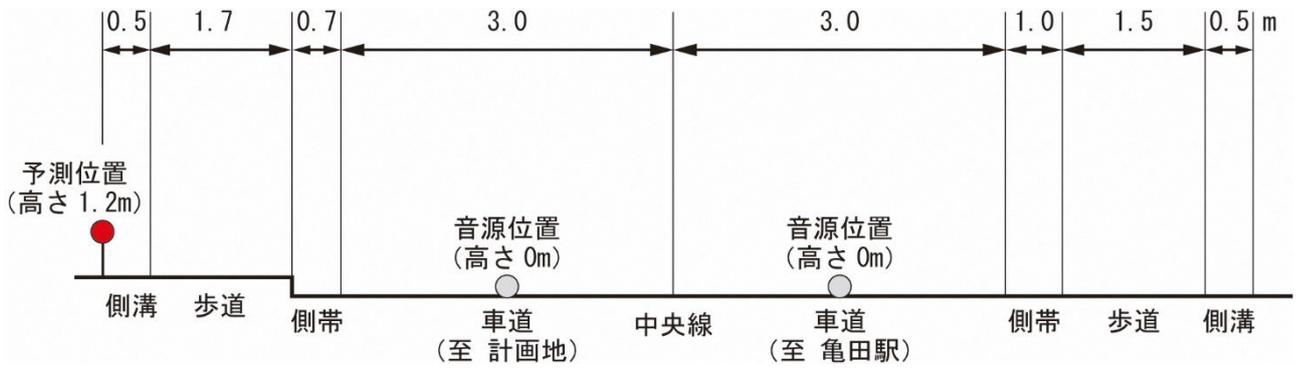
(6) 道路断面図 (No.6 : 新潟新津線沿道)
